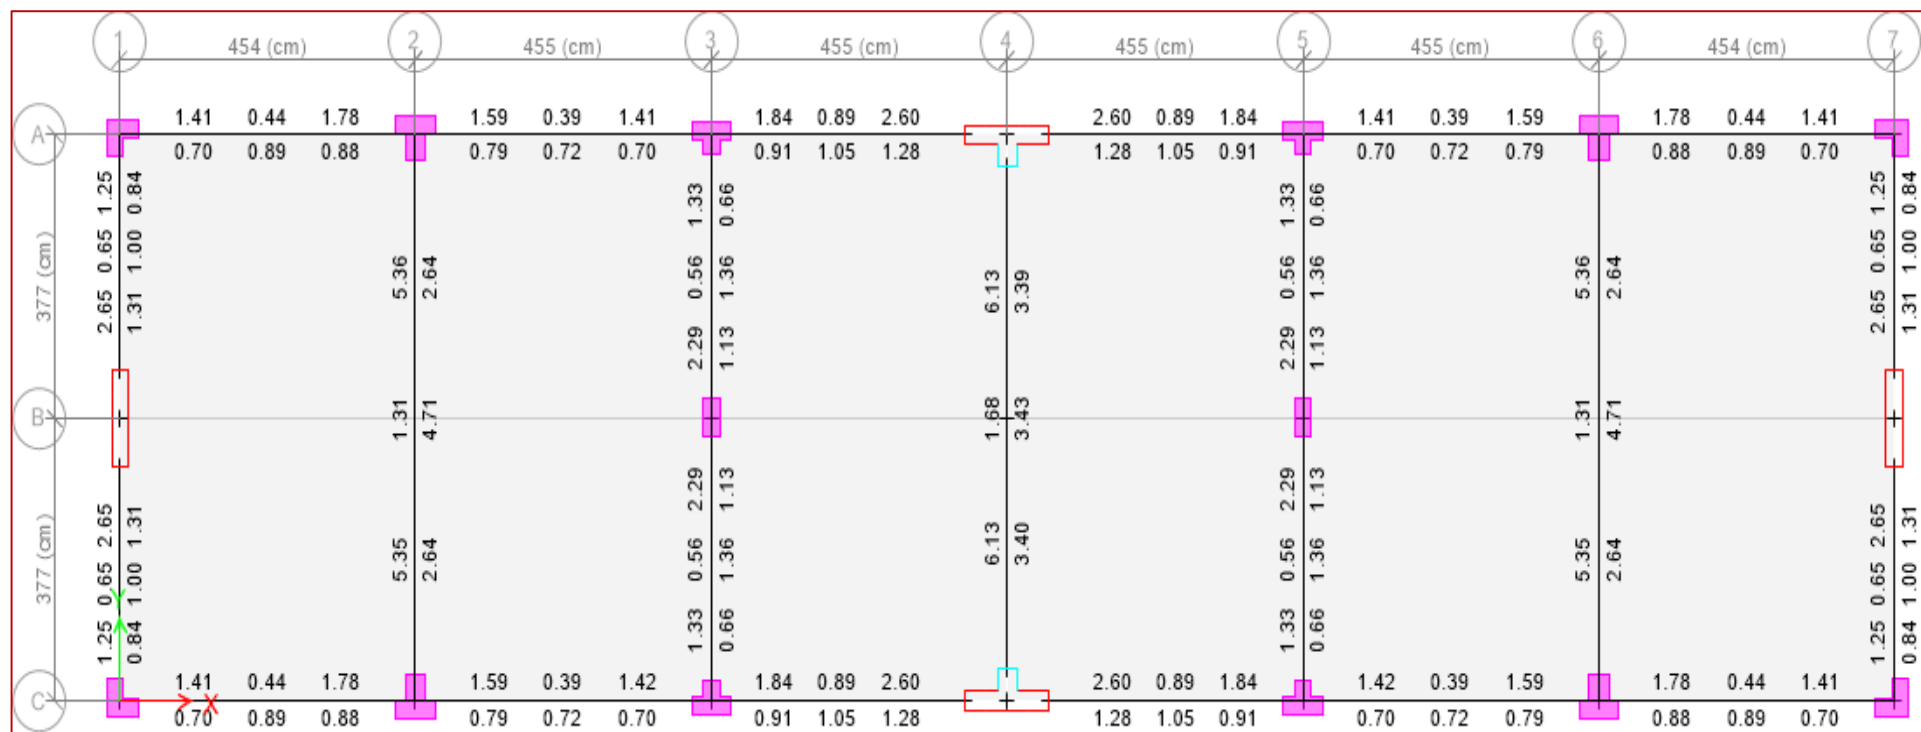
Acero Necesario en Vigas para el Modulo: Aulas, en el Software Etabs V.16.2.1
